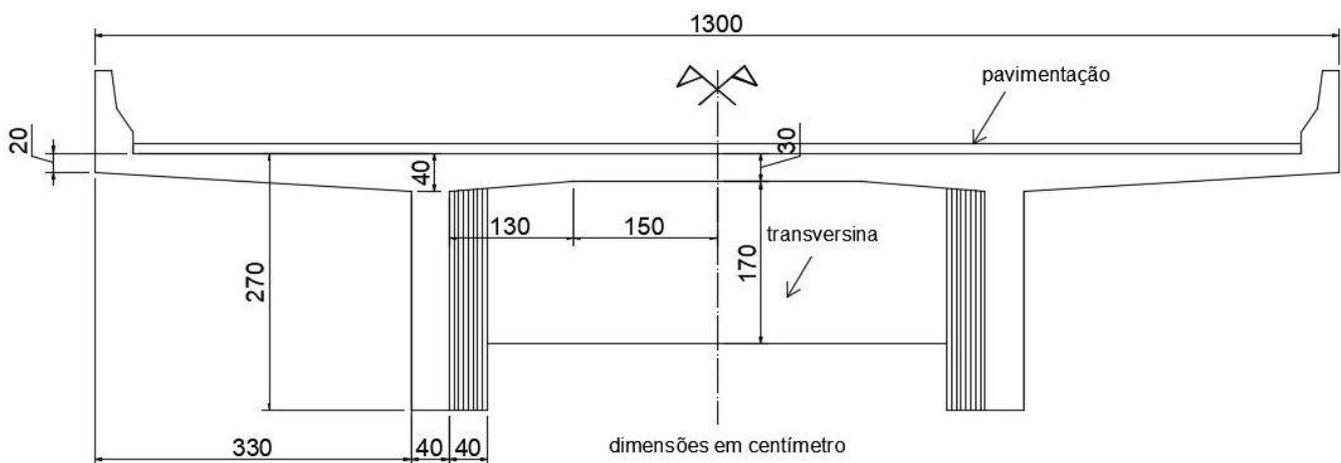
Seção transversal da superestrutura da ponte no apoio intermediário.
